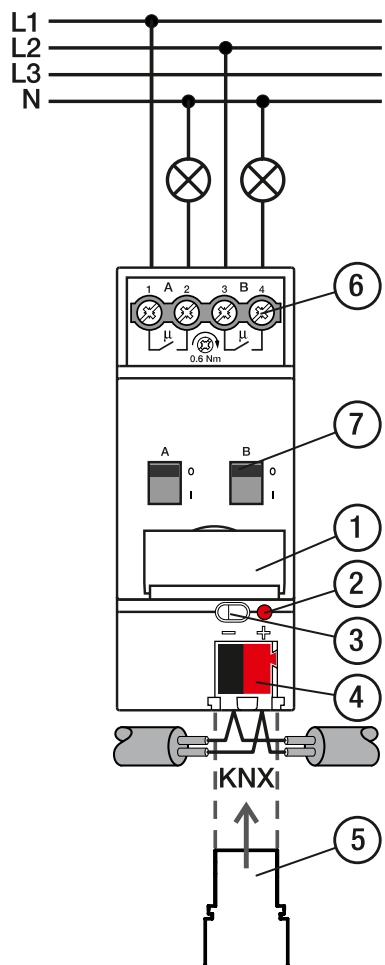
Schema di collegamento SA/S 2.x.x.2
